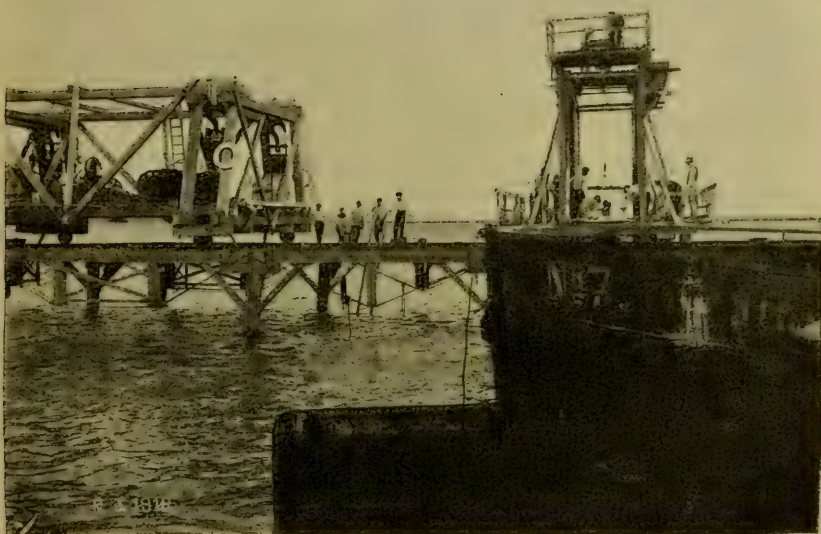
Sección subfluvial. Carros para fondeo y cimentación de los conductos
